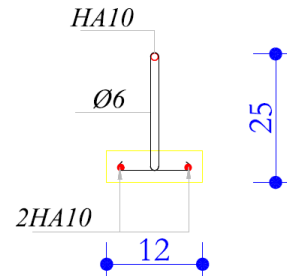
ferrailage des poutrelles d'étage courant et terrasse
